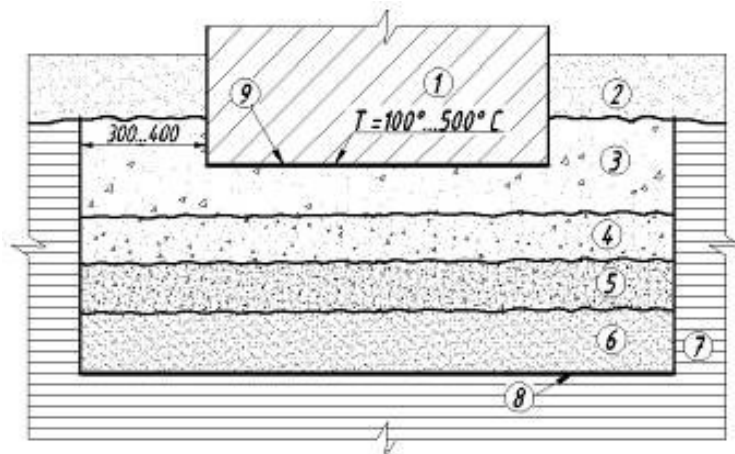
Конструкция «многослойной защиты» основания из набухающих глинистых грунтов под фундаментами промышленных печей в гидротермальных условиях увлажнения:
